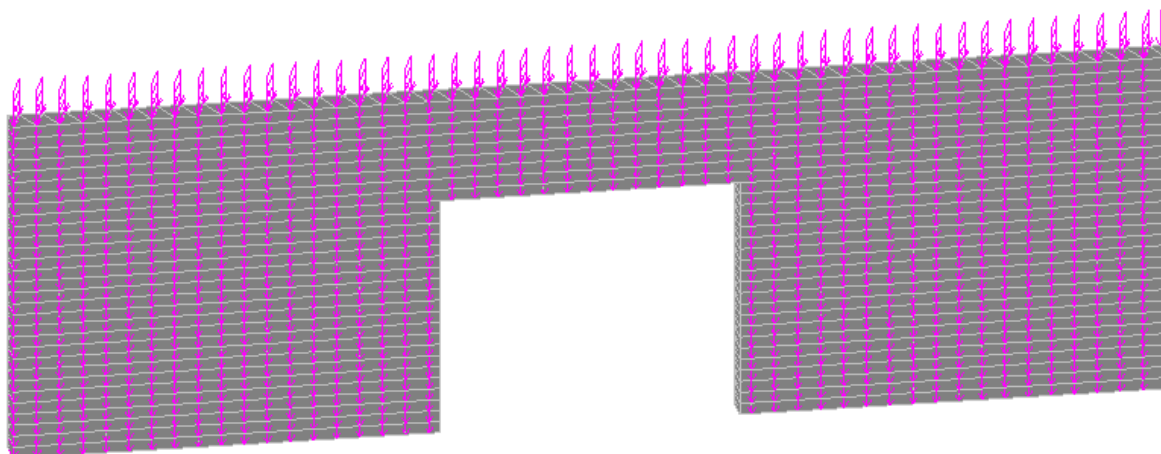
Приложение вертикальной нагрузки к простенку
